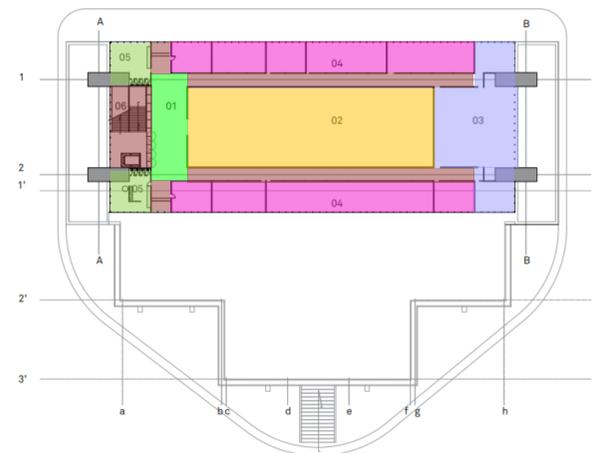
Planta baixa do nível +8.50. Fonte: Archdaily A, 2019.
